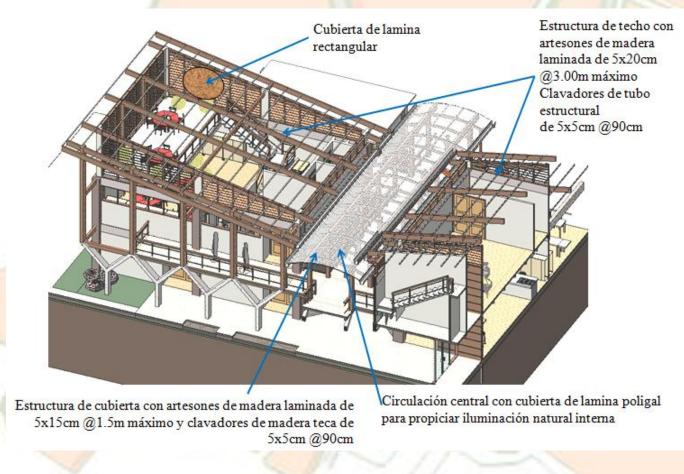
Sistema constructivo para las cubiertas de la propuesta del Centro Comunal. Fuente: propia
